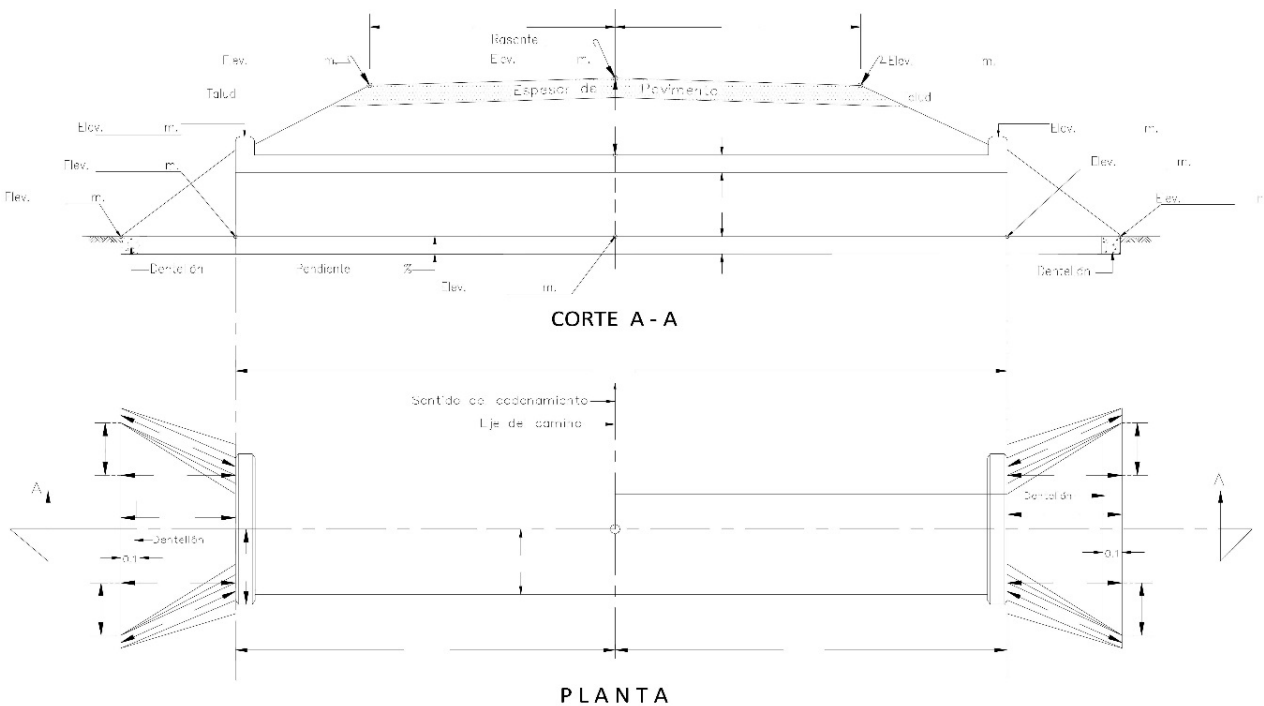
Obra de drenaje propuesta para el proyecto: cajón prefabricado.
